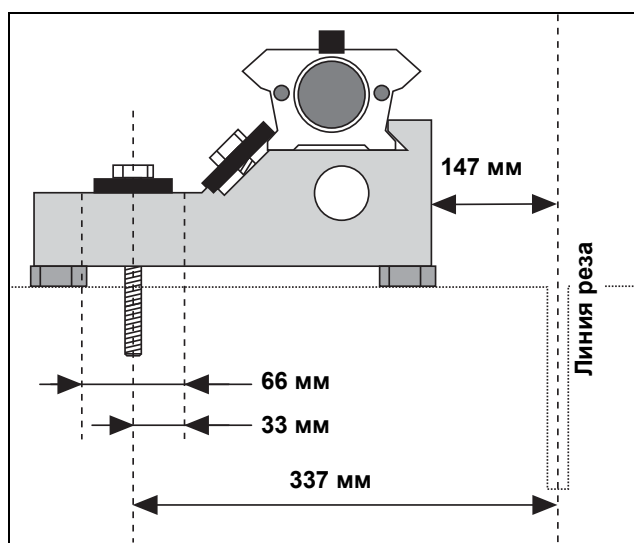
Габаритные размеры для дюбельного крепления с рельсовой колодкой, № заказа 56 15
